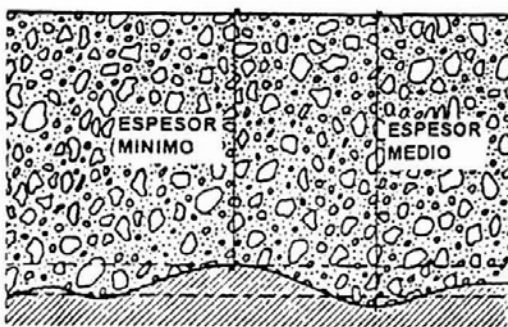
Esquema de la variación de Espesores en el Pavimento de Concreto.
